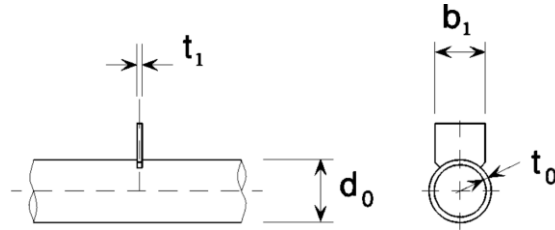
JUNTA SOLDADA EM T COM CHAPA DE *GOUSSET* TRANSVERSAL (EC3-1-8, QUADRO 7.3)
